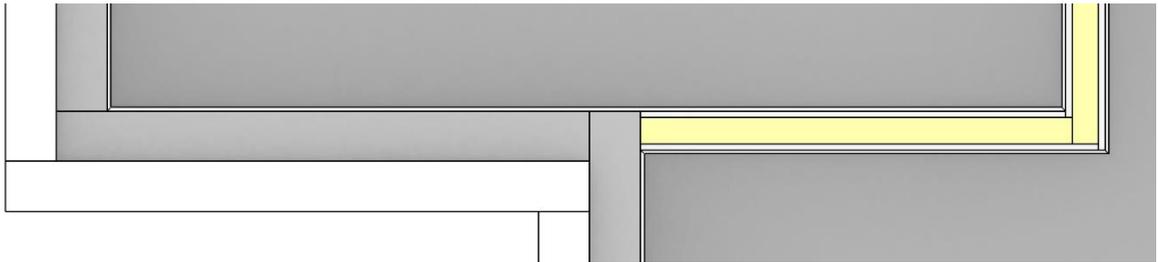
Verschneidung Außenwand und Ausbaufäche, Grundriss (Screenshot)
